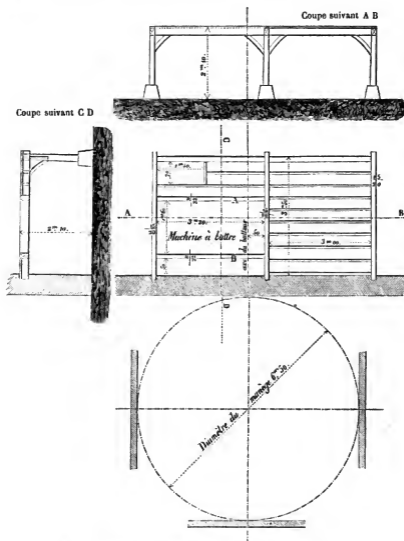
Installation d'une machine à battre du système Duvoir.
